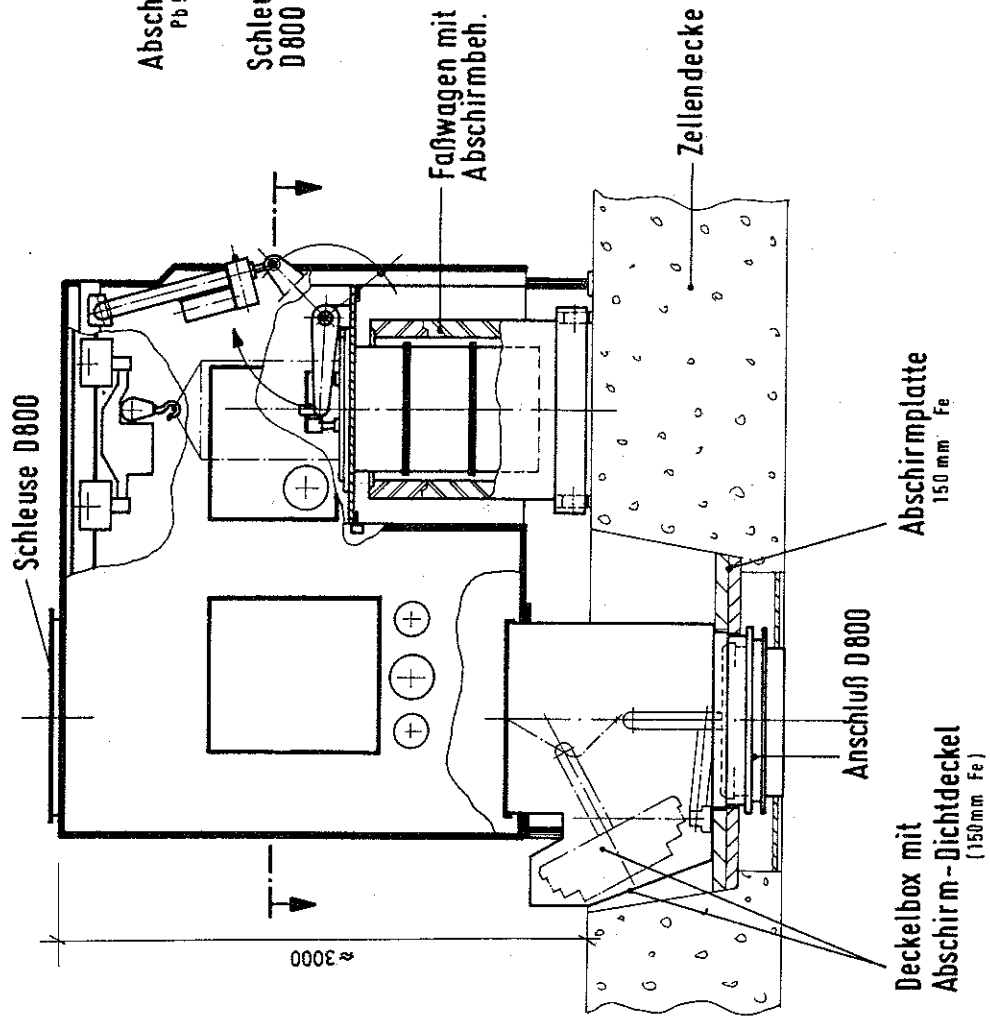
Längsschnitt der Beton Zellen mit mögl. Aufbauten
